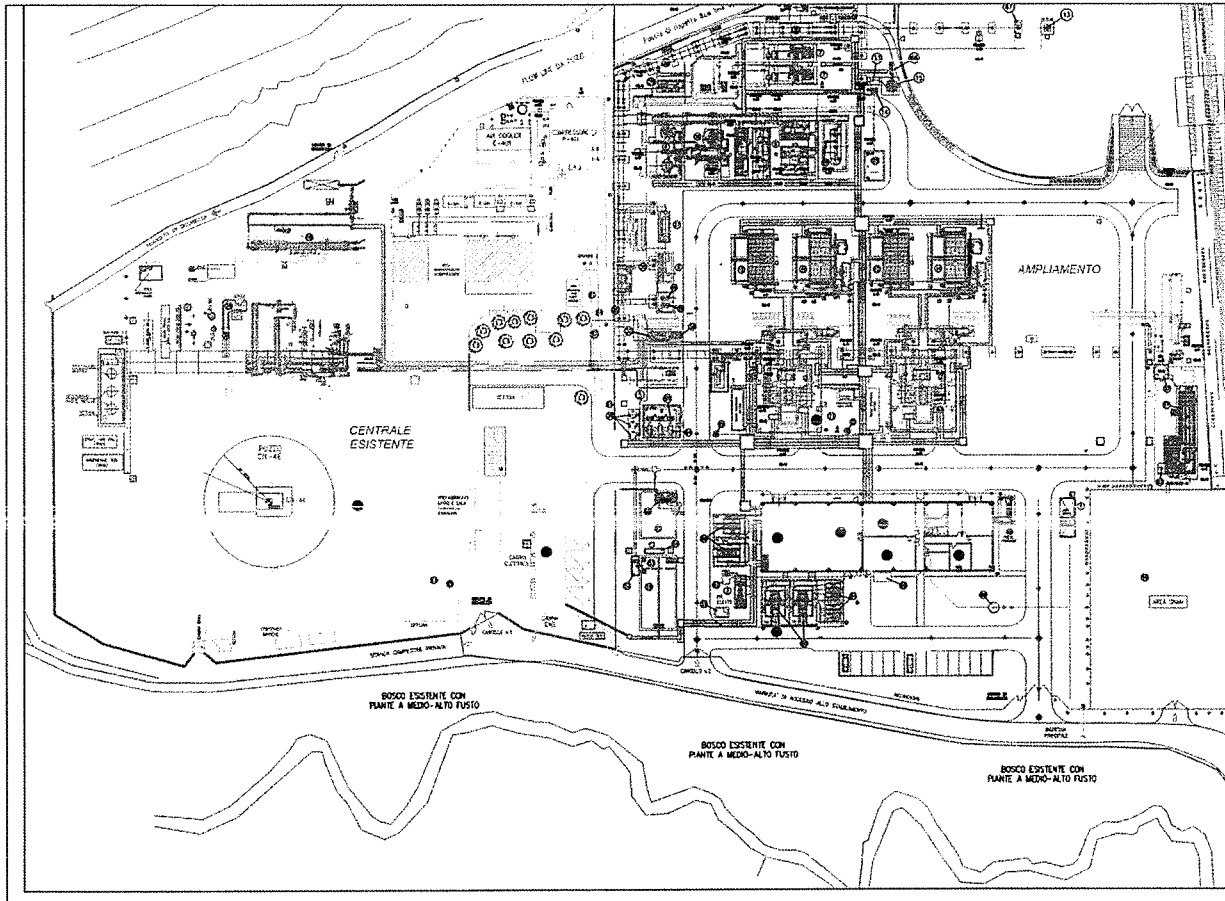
planimetria della centrale di stoccaggio sita in località Collalto (TV)
